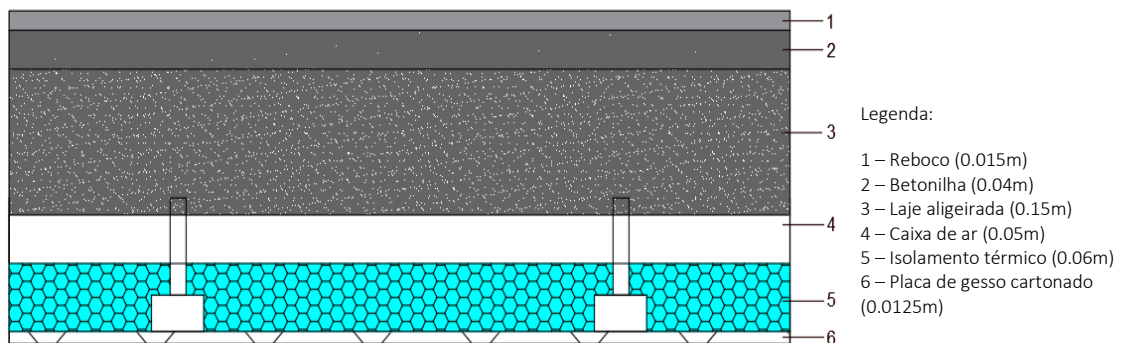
Pormenor construtivo referente à solução construtiva isolamento na esteira horizontal na face inferior – teto falso
